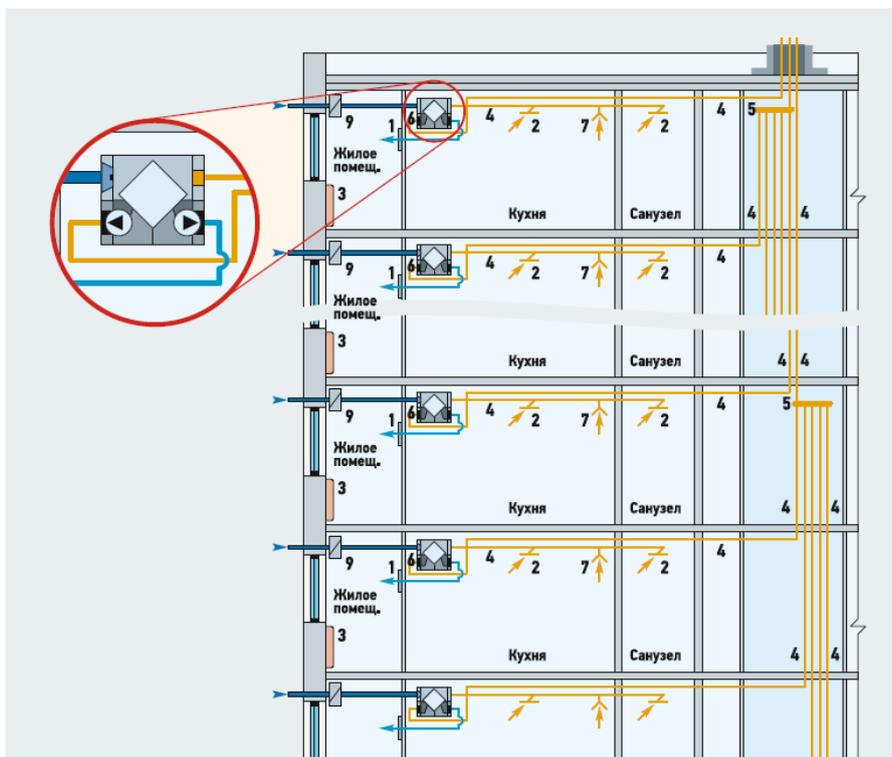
Индивидуальная зональная схема вентиляции в здании
